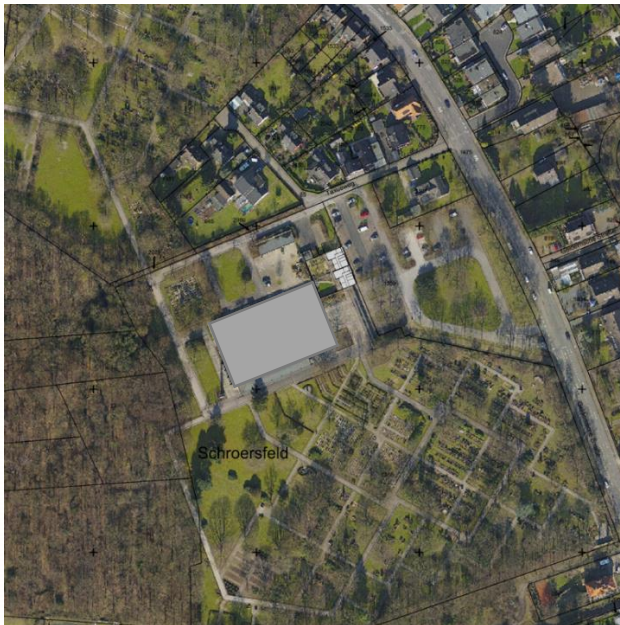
Lage des heutigen Friedhofsgebäudes bzw. angedachten Bestattungszentrums (einschließlich Vorplatzfläche)
